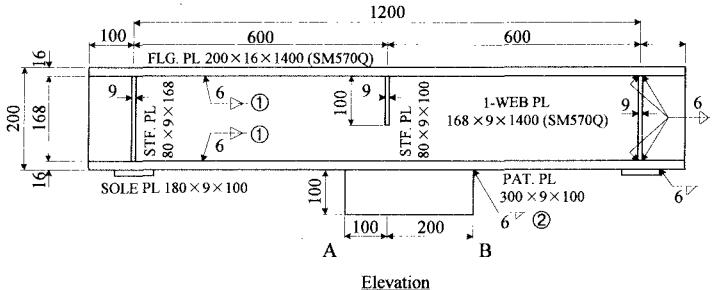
吊金具付き桁試験体の形状と寸法 (単位は mm)
